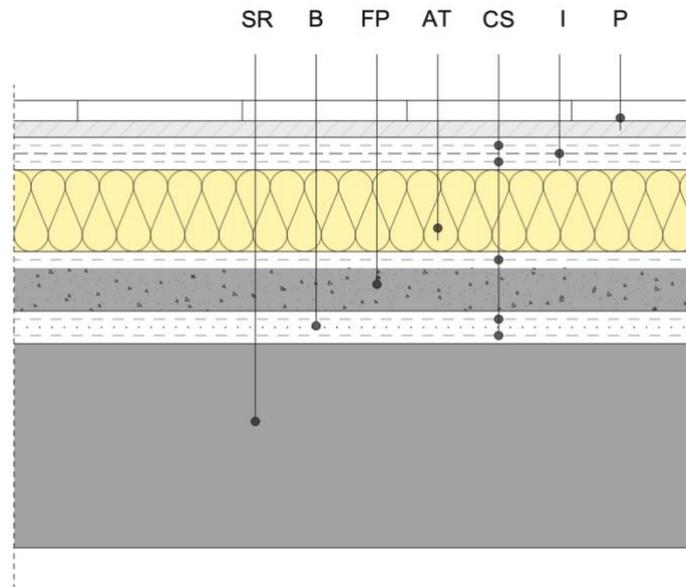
Cubierta convencional. Formación de pendientes con hormigón celular. Leyenda: SR Soporte resistente. B Barrera cortavapor. FP Formación de pendiente. AT Aislante térmico. CS Capa separadora. I Impermeabilización. P Protección.
